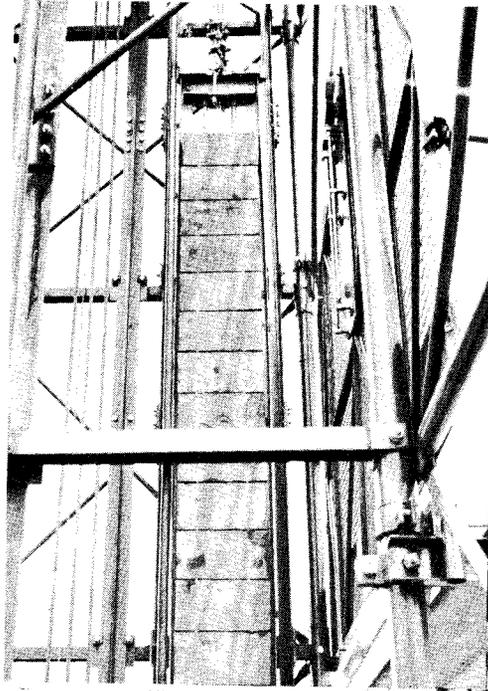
Vista demostrando el contrapeso del montacargas instalado dentro del pozo de la torre.
